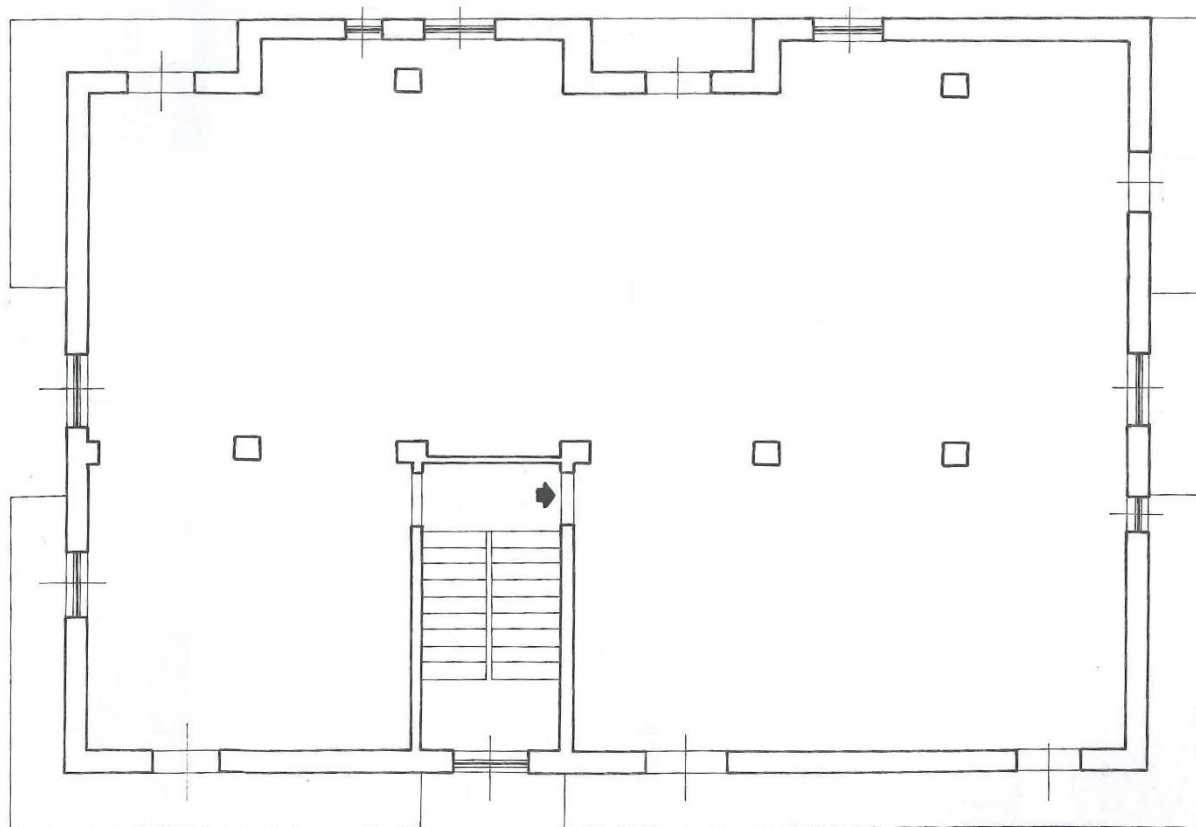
Pianta piano primo, indiviso. Stato di fatto.
